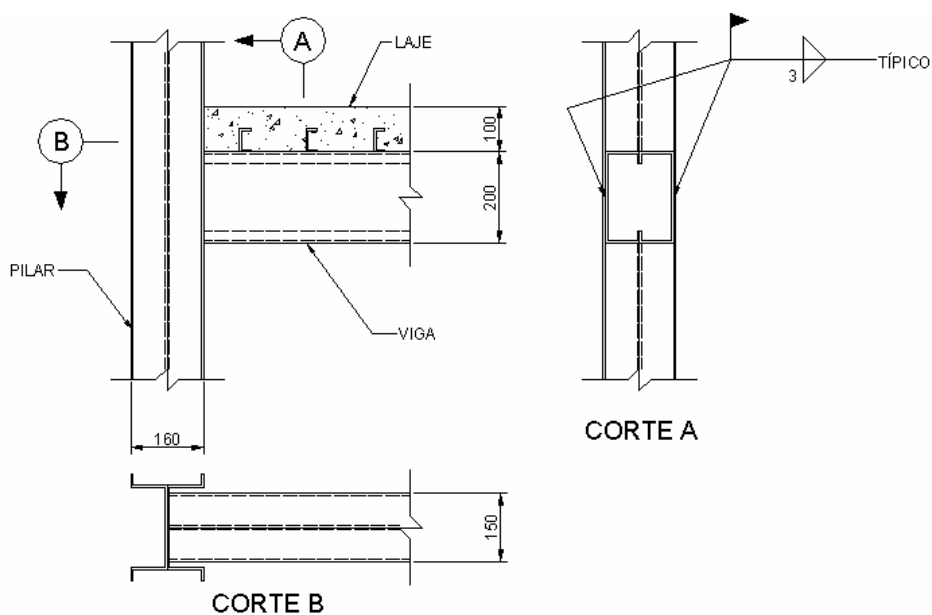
Detalhe construtivo da ligação Viga – Pilar na direcção x [3]
